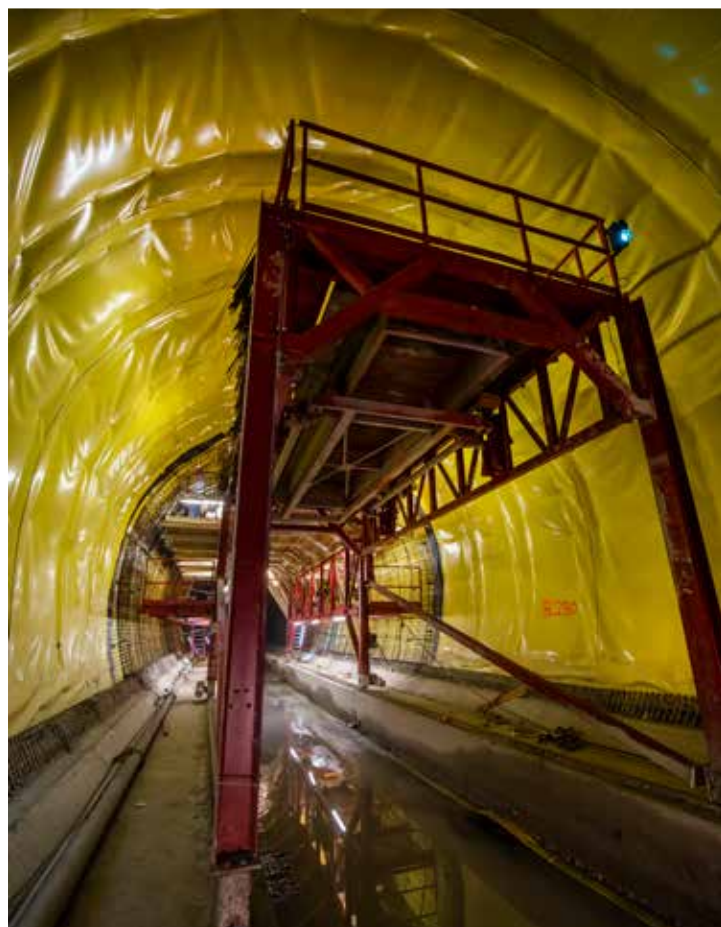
Bewehrungsgerüst im Verbindungstunnel mit Profil RH
